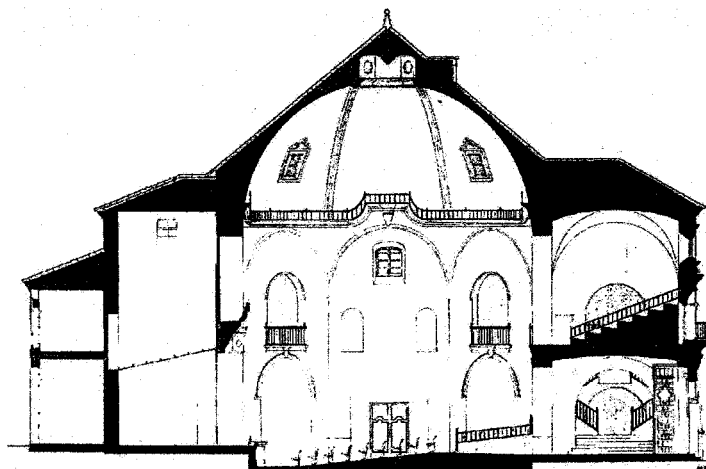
Sección longitudinal del proyecto de restauración.
